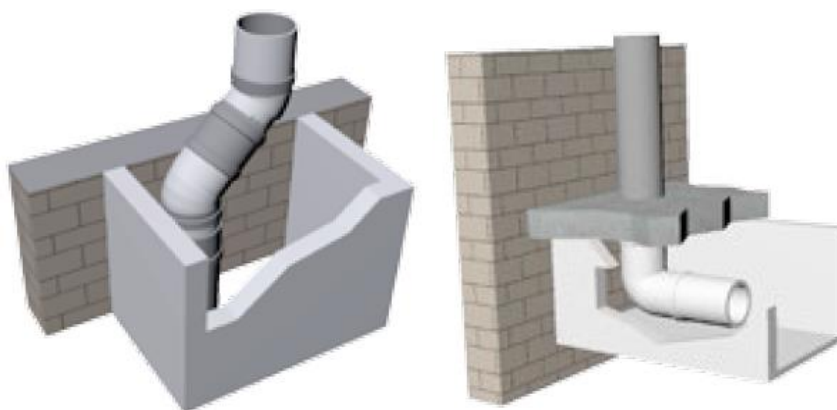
Conduit avec dévoiement oblique (2 x 45 °) ou dévoiement à 90 ° avec soffite.
